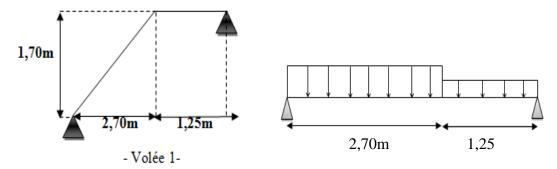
Schéma statique d'escalier type 01 (cage d'escalier 2).
